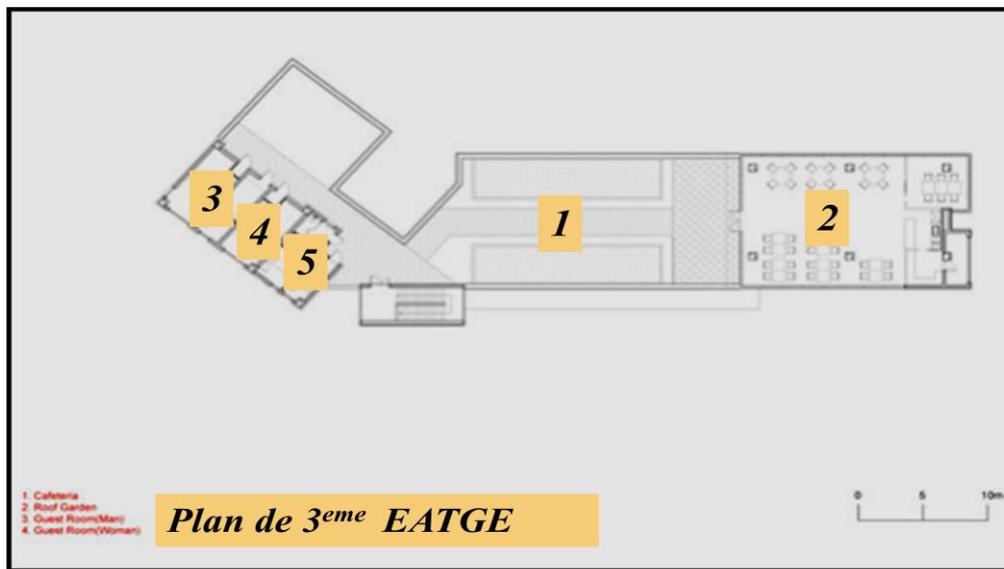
Plan de 3^{ème} étage du centre.⁸⁶
